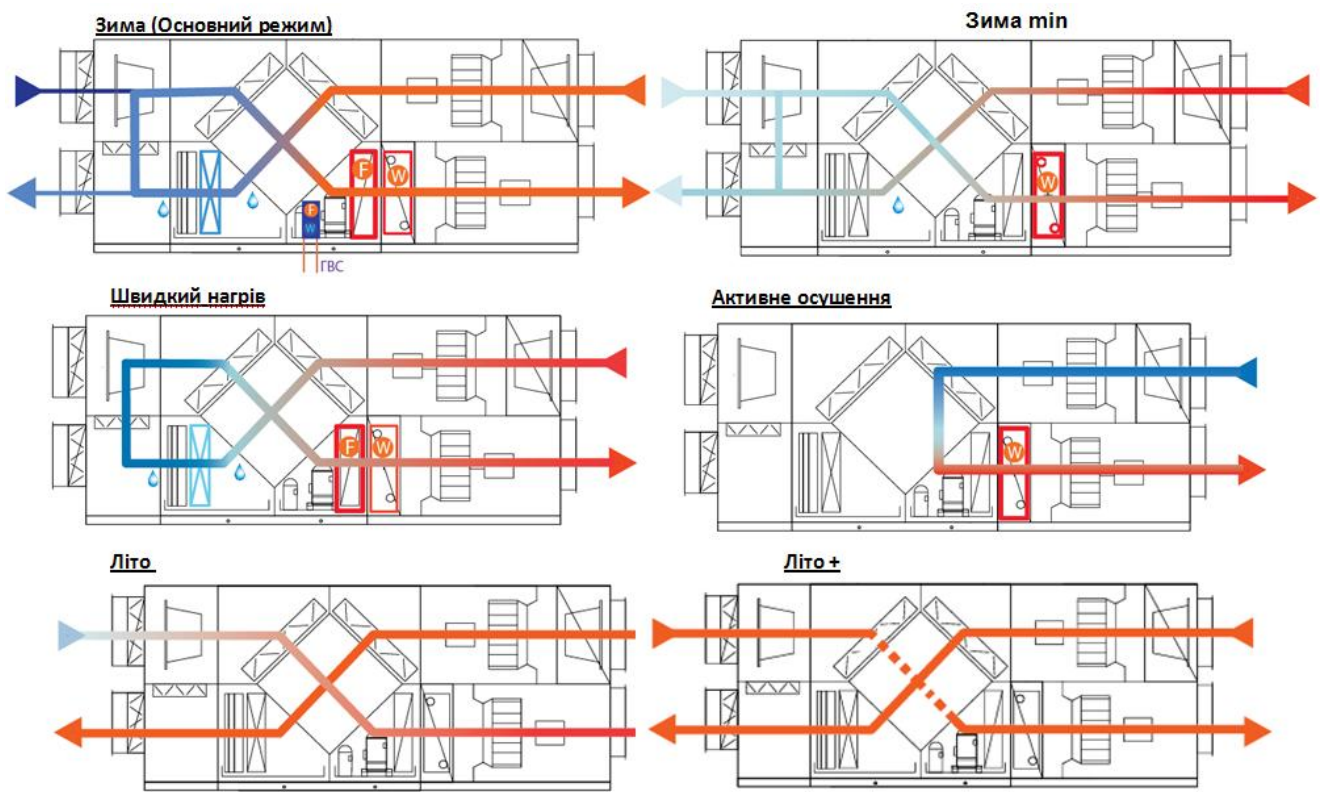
Схема припливно-витяжної установки з пластинчастим рекуператором
